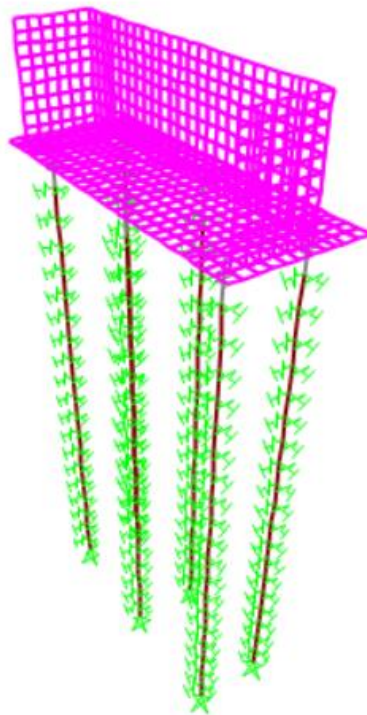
Estribos Puente de Vigas Isostáticas (dimensiones en cm).
